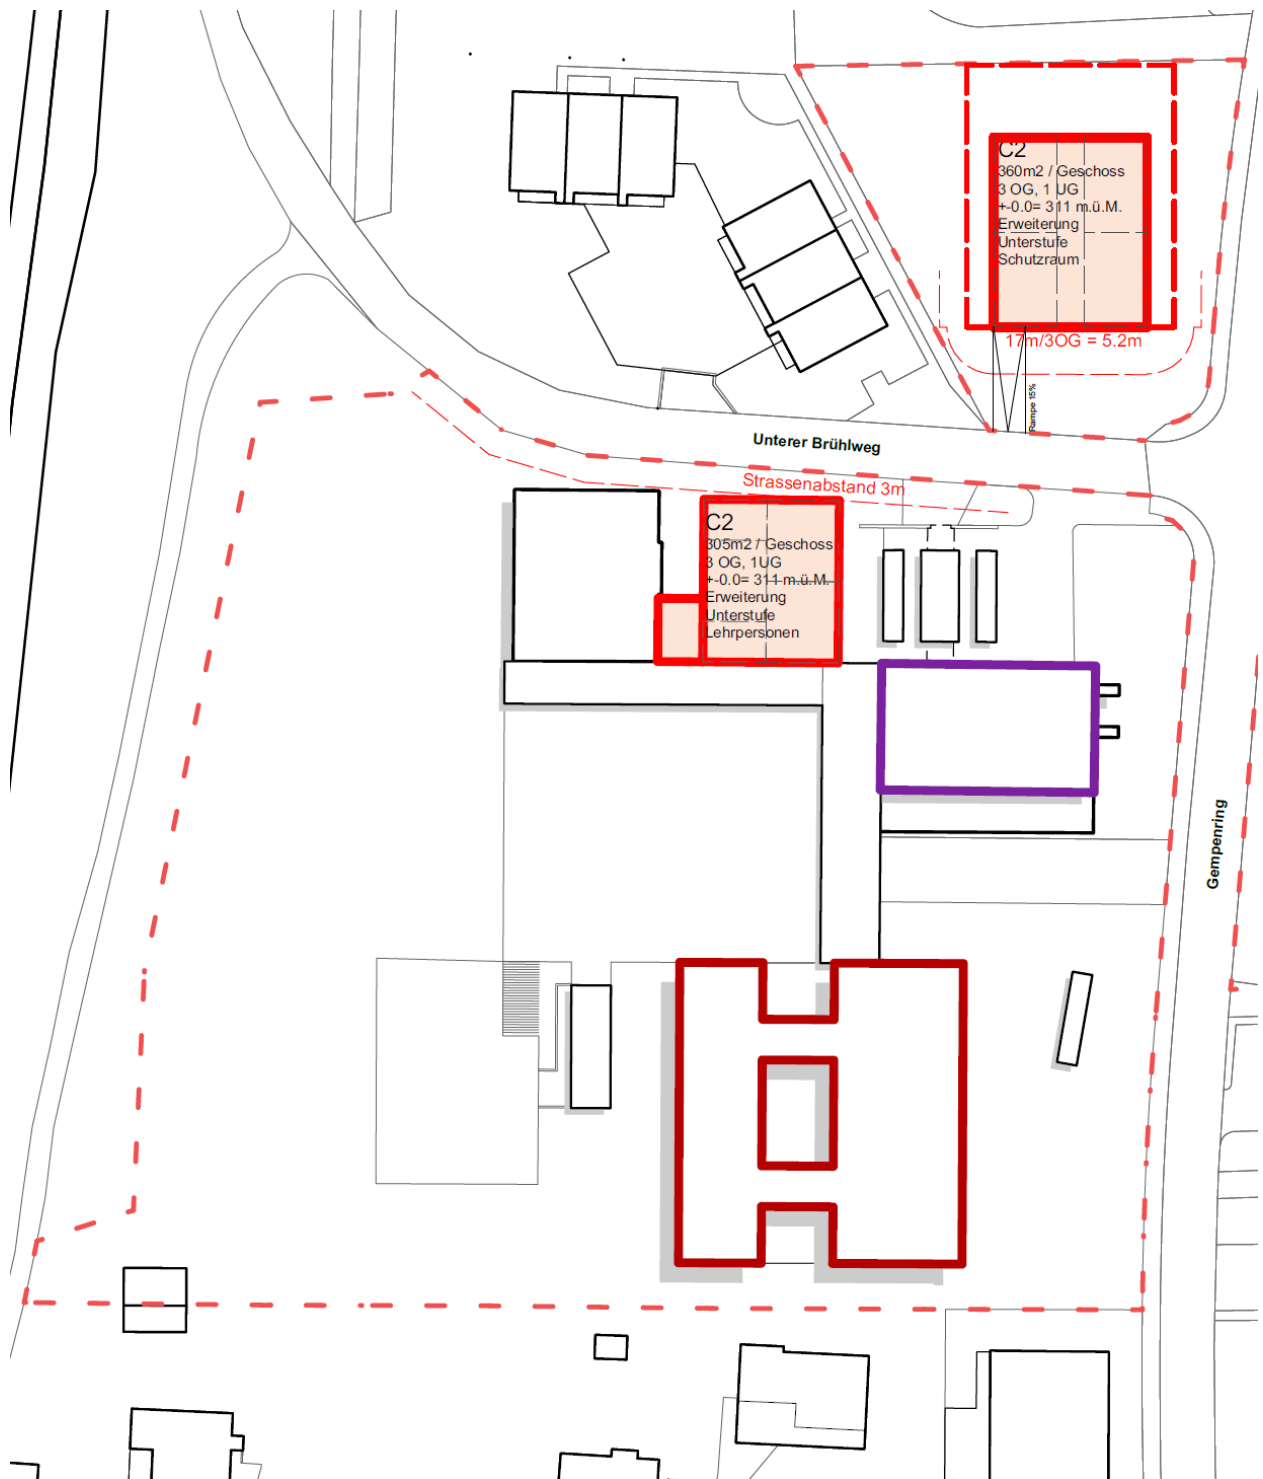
Etappe 1, Grundriss C.2
